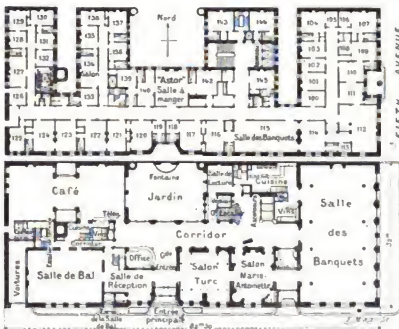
Hôtel Waldorf. Plan du premier étage et du rez-de-chaussée.
